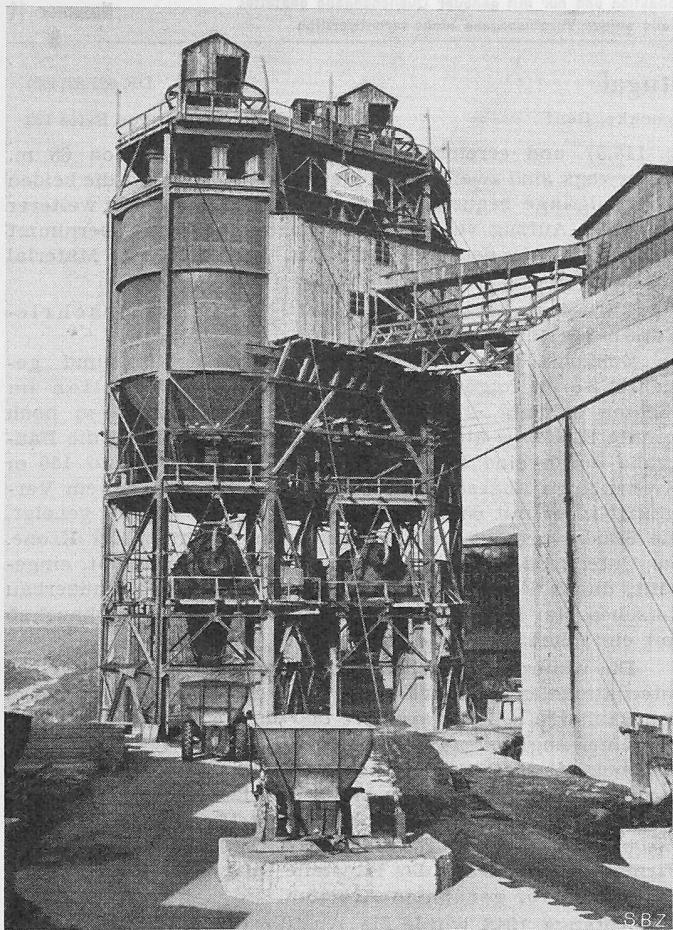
Betonieranlage mit angebauter Eiserzeugung
